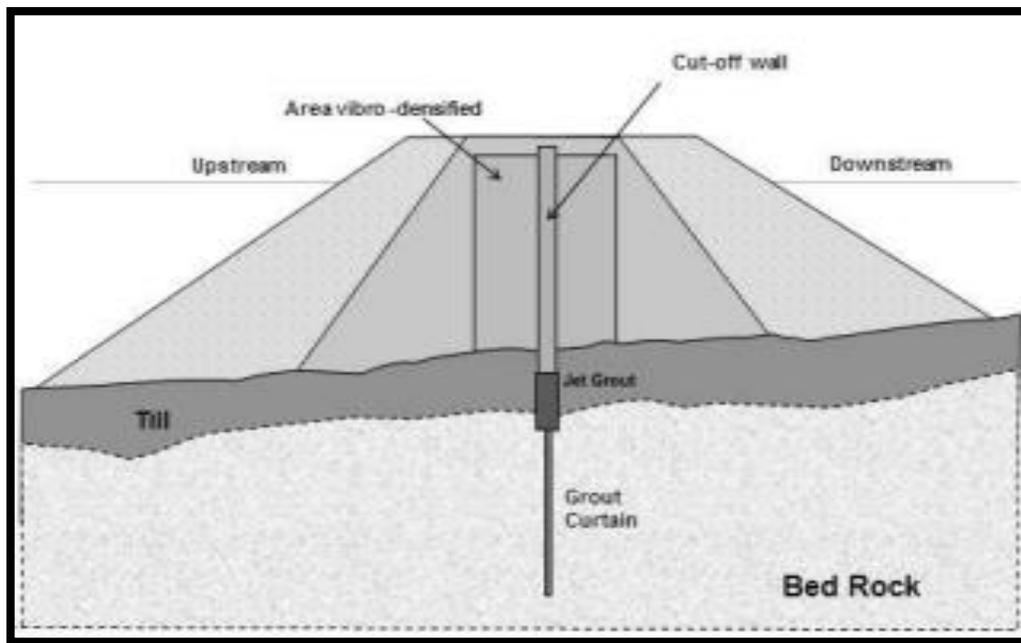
l'installation d'une paroi étanche (Schwank, 2019)
